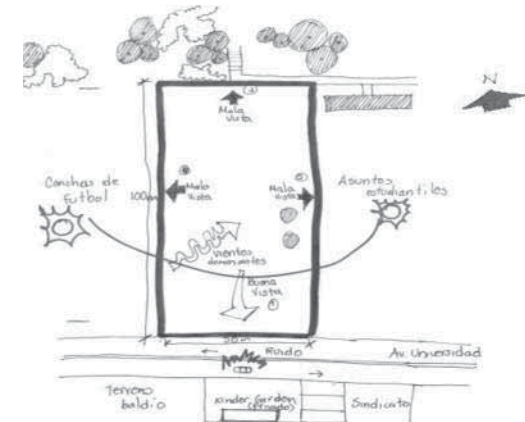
Croquis del terreno elegido para proponer la guardería dentro de CU.
